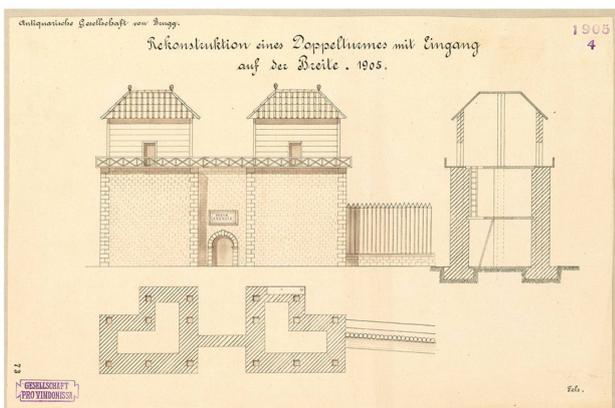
Das Nordtor des Legionslagers Vindonissa in einer Rekonstruktionszeichnung von C. Fels 1905. Darunter der vereinfachte Grundrissplan (Norden ist unten). Die Tortürme zeigen jeweils einen hölzernen Aufbau und Walmdach auf massivem Unterbau; über dem Portal der Feindseite die fiktive Inschrift «Porta Arensia» (Kantonsarchäologie Aargau, Plan V 73).
